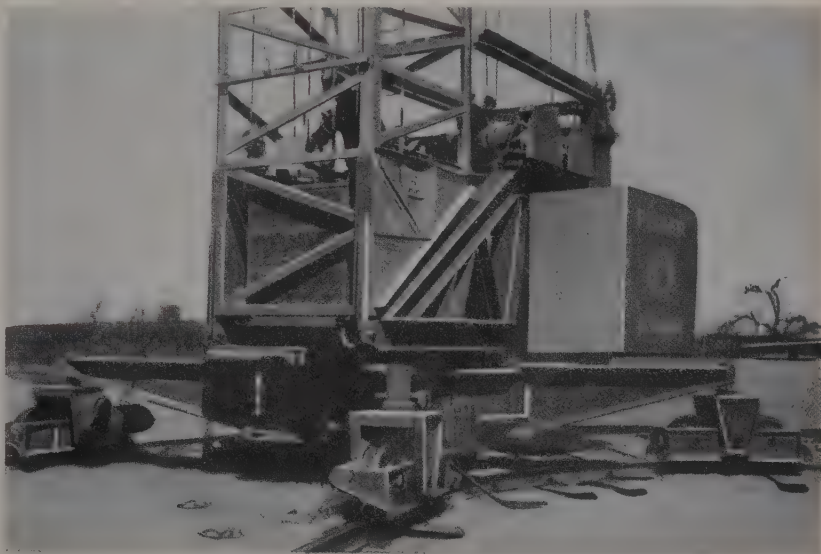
Peiner Turmdrehkran mit Sonderunterbau für kurvengängigen Betrieb
